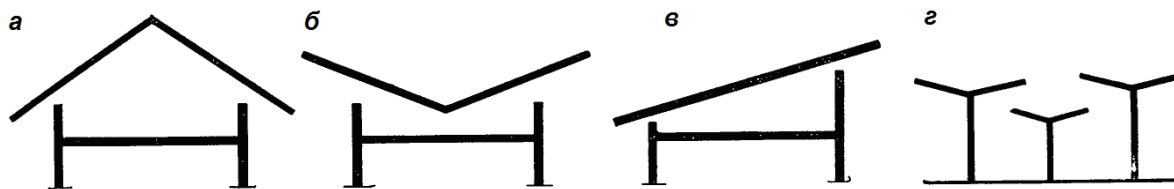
Покрытия зданий во влажном жарком климате:
